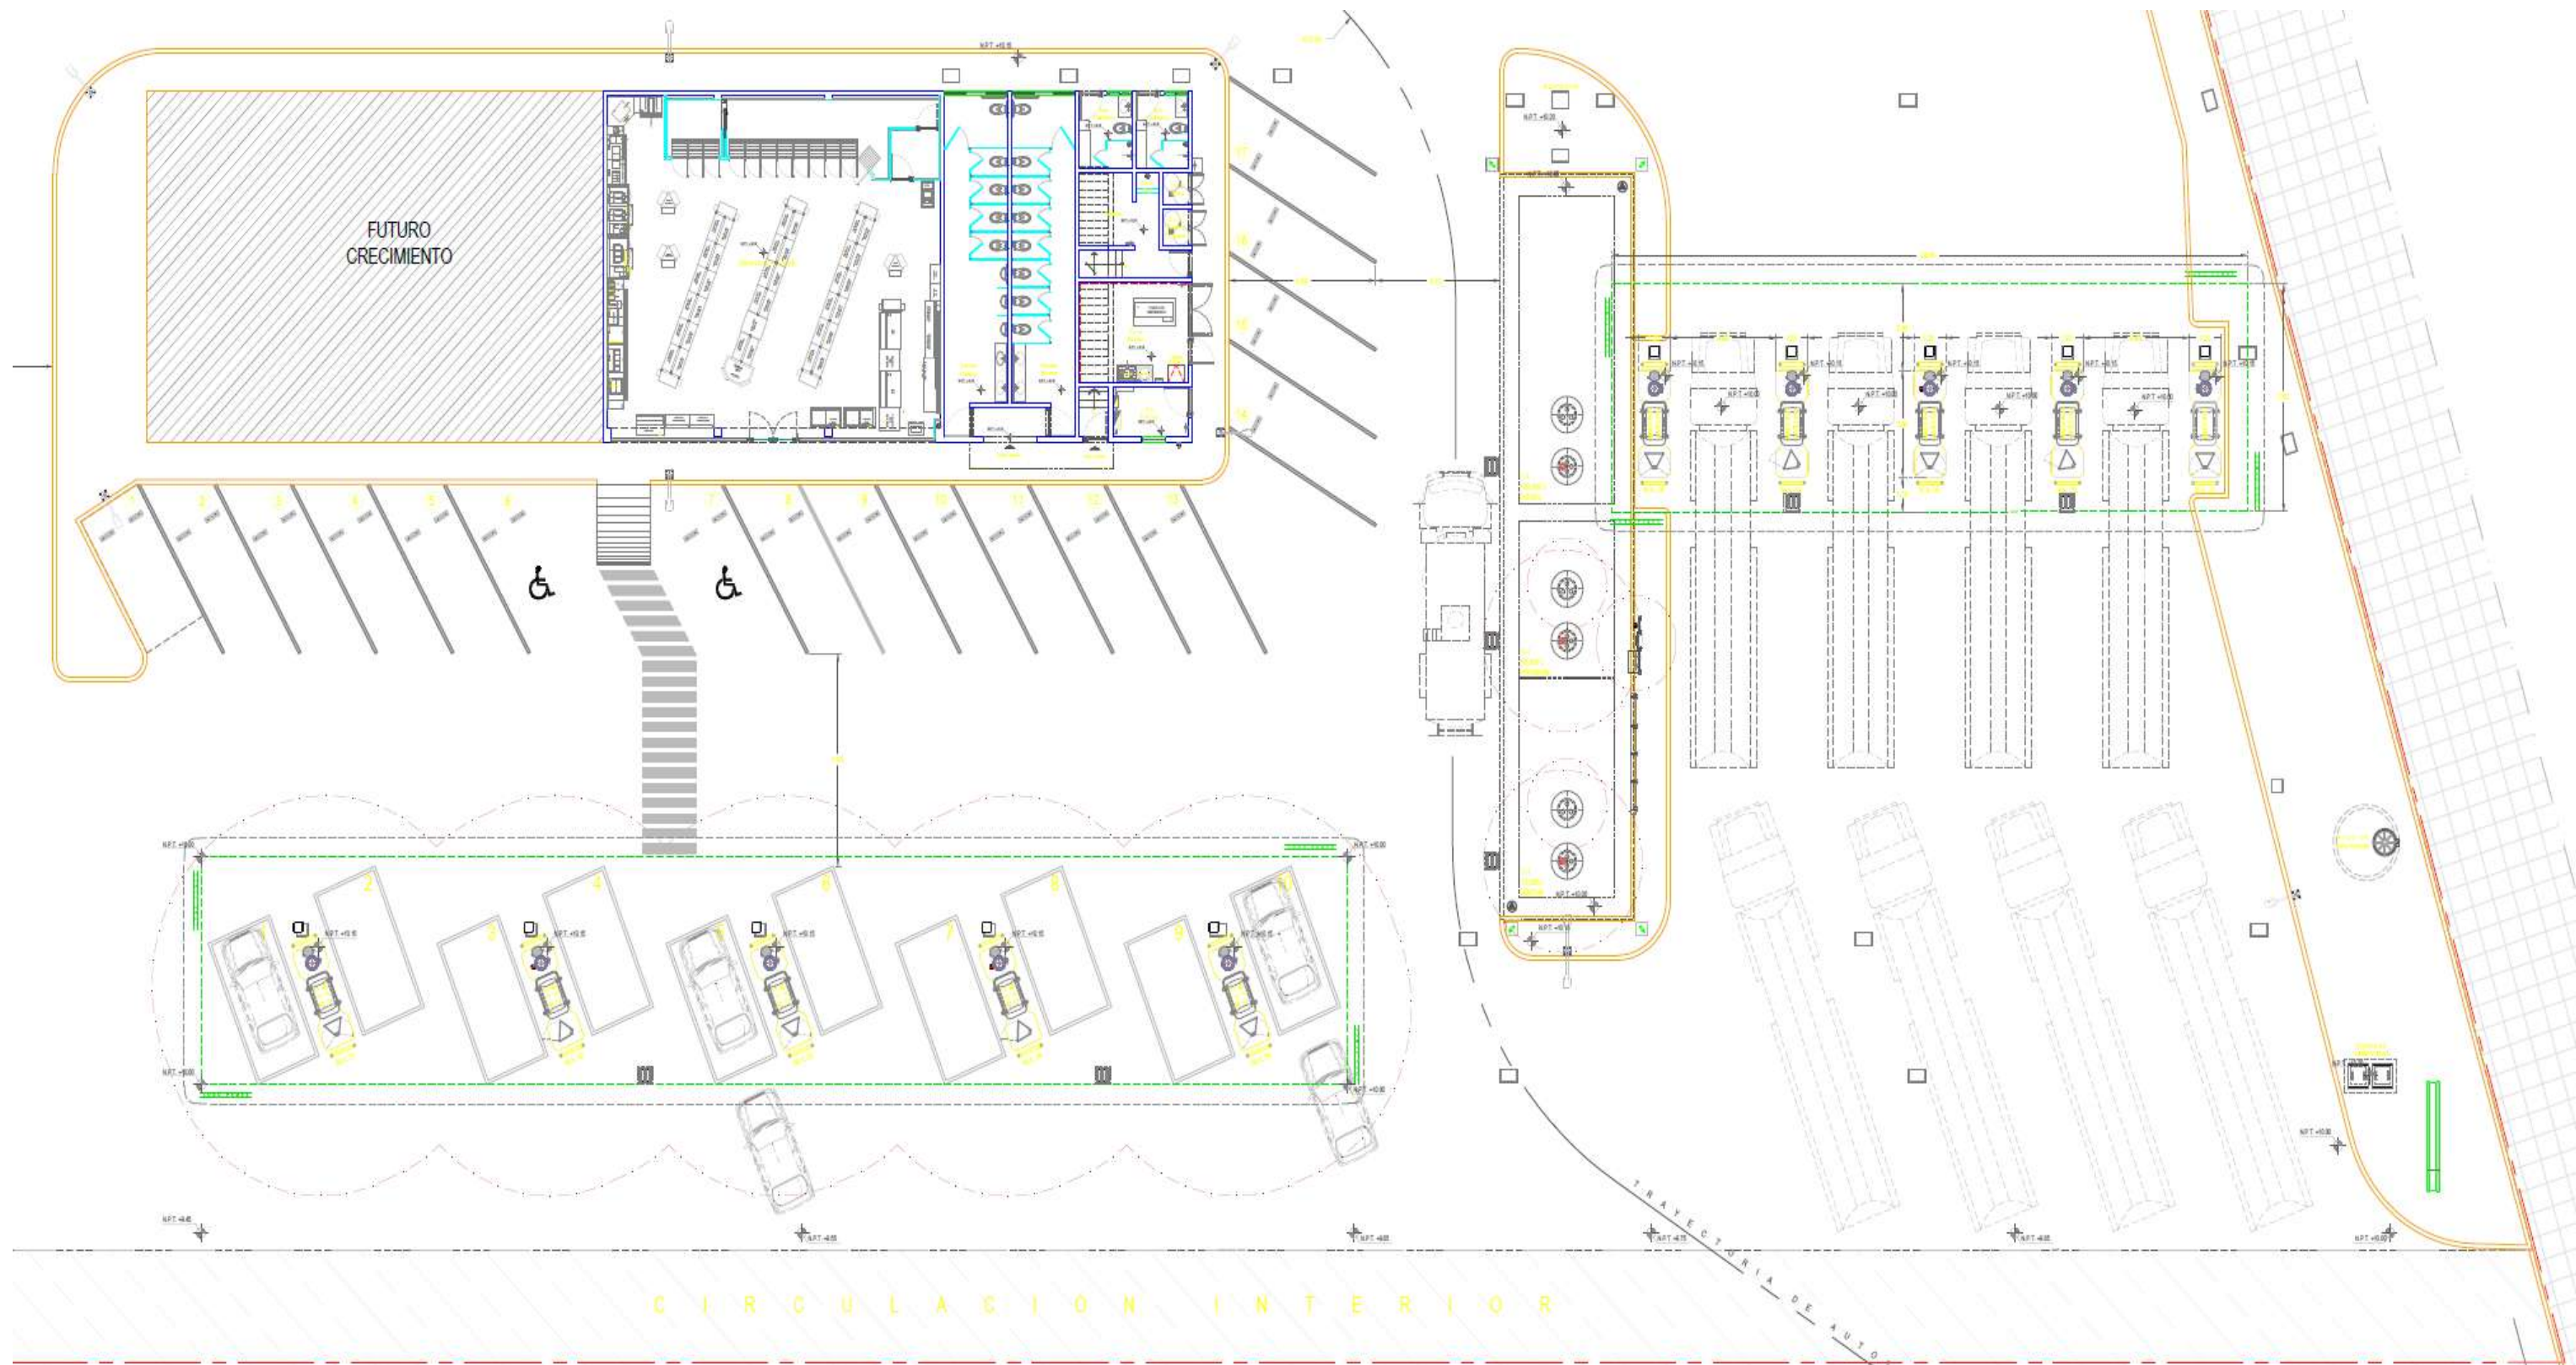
Planta arquitectónica general de la Estación de Servicio a detalle
